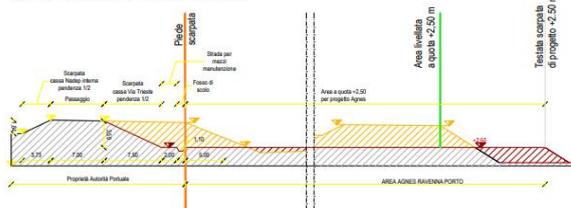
Plano-altimetrico dell'area Agnes Ravenna Porto
